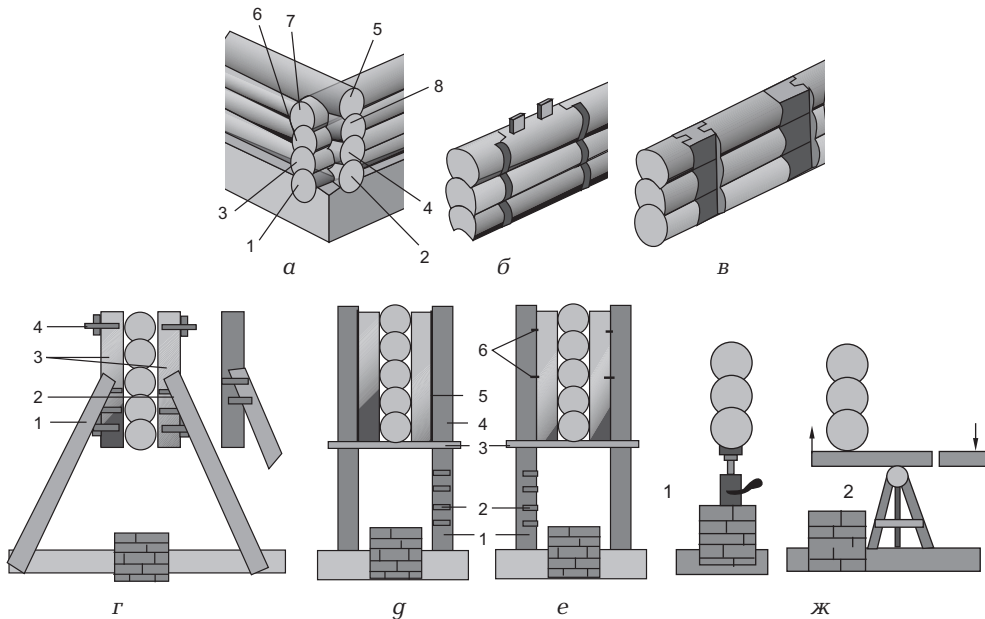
Ремонт стен рубленых домов: а — расположение венцов: 1 — нижний, или первый, брус окладного венца; 2 — верхний, или второй, брус окладного венца; 3–8 — брус рядовых венцов; б — замена бруса под окнами обычным способом; в — замена бруса под окнами с постановкой стоек; г — вывешивание стен дома с помощью сжима и подкосов: 1 — подкос; 2 — скоба; 3 — сжимы; 4 — болт; г, е — вывешивание стен дома: 1 — стойка; 2 — отверстие; 3 — штыри; 4 — болт; 5 — брусок сжима; 6 — скобы; ж — подъем стены вагами и домкратом: 1 — подъем стены домкратом; 2 — установка балки-рычага, на которой удерживается стена без домкрата
